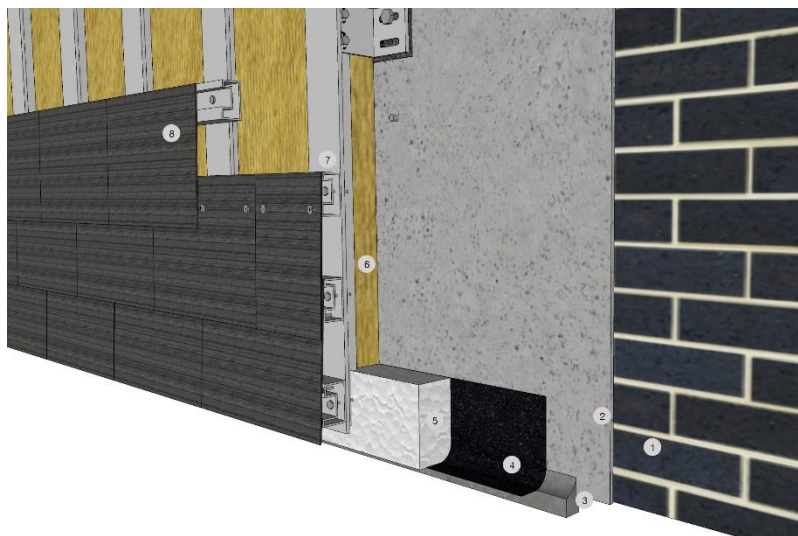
Detalle arranque fachada ventilada. Encuentro con el suelo
